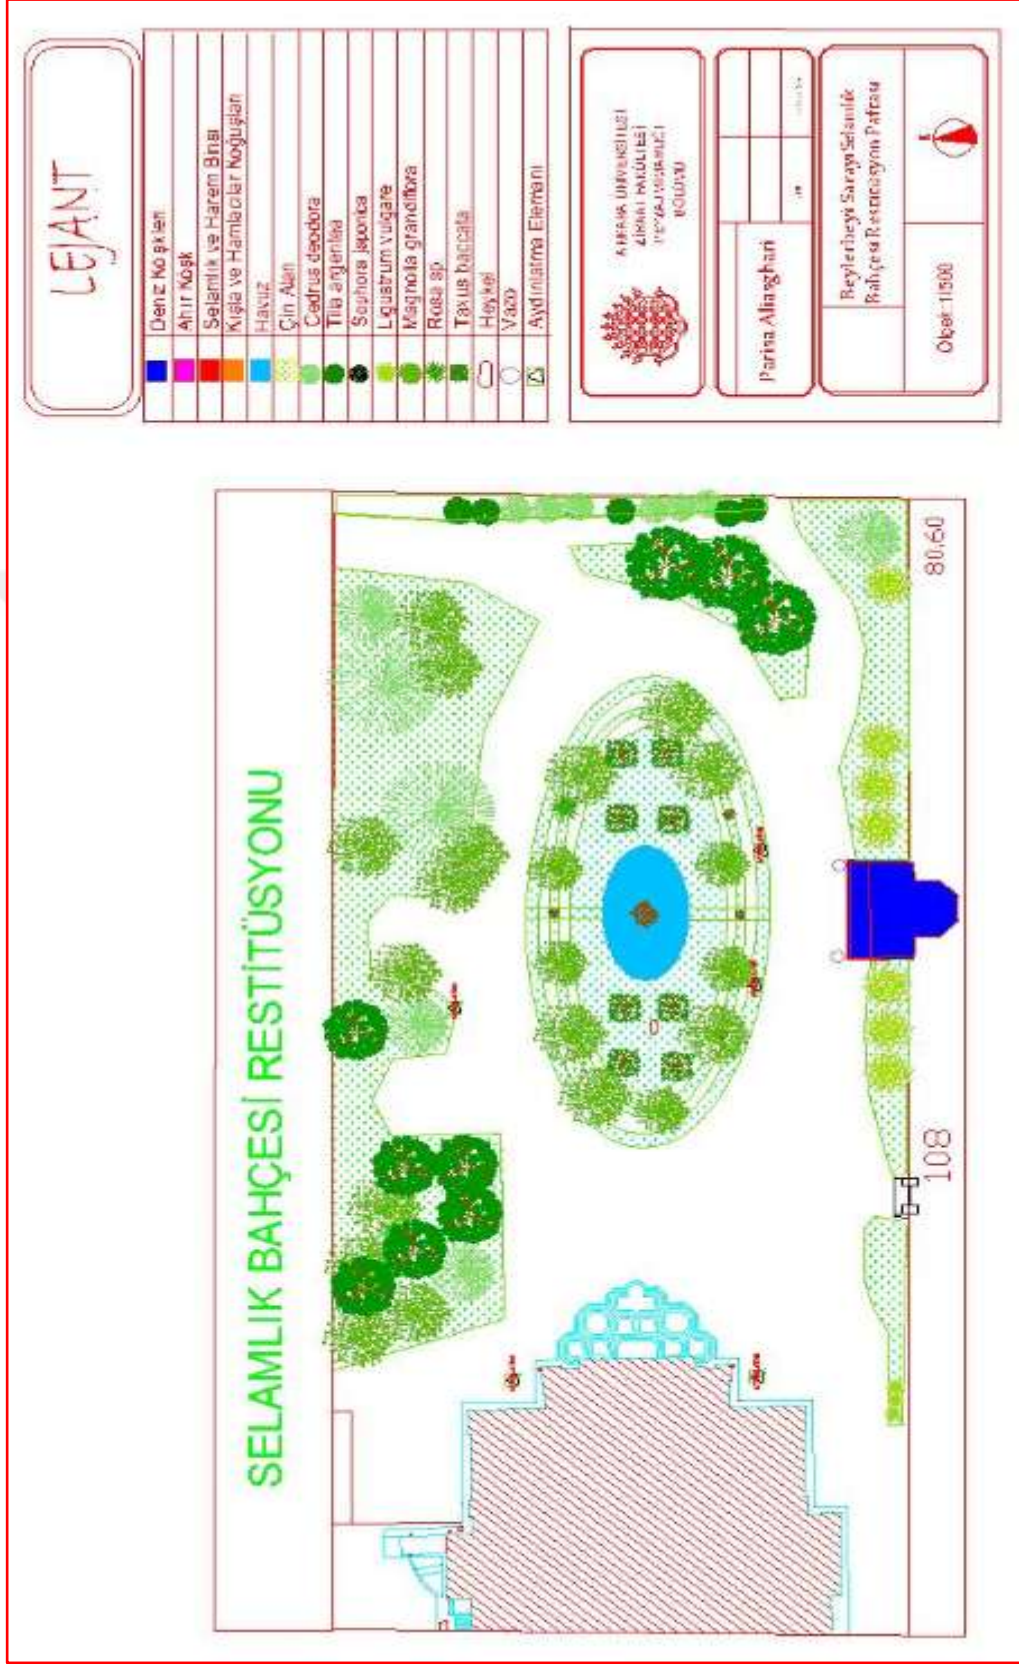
Beylerbeyi Sarayı Selamlık bahçesi 1960 yılı yerleşim planı (Orijinal 2016)
